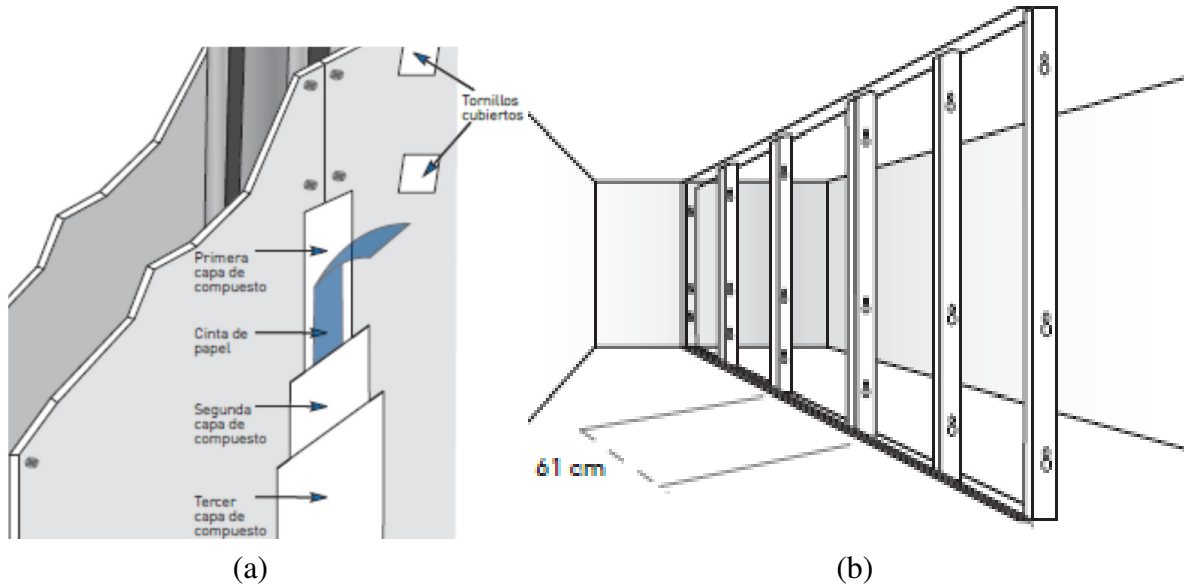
Panel W<sup>®</sup>; a) Tablero (Panel W<sup>®</sup>, 2016) y b) Detalle constructivo de colocación de muros (Panel W<sup>®</sup>, S.F.b).
